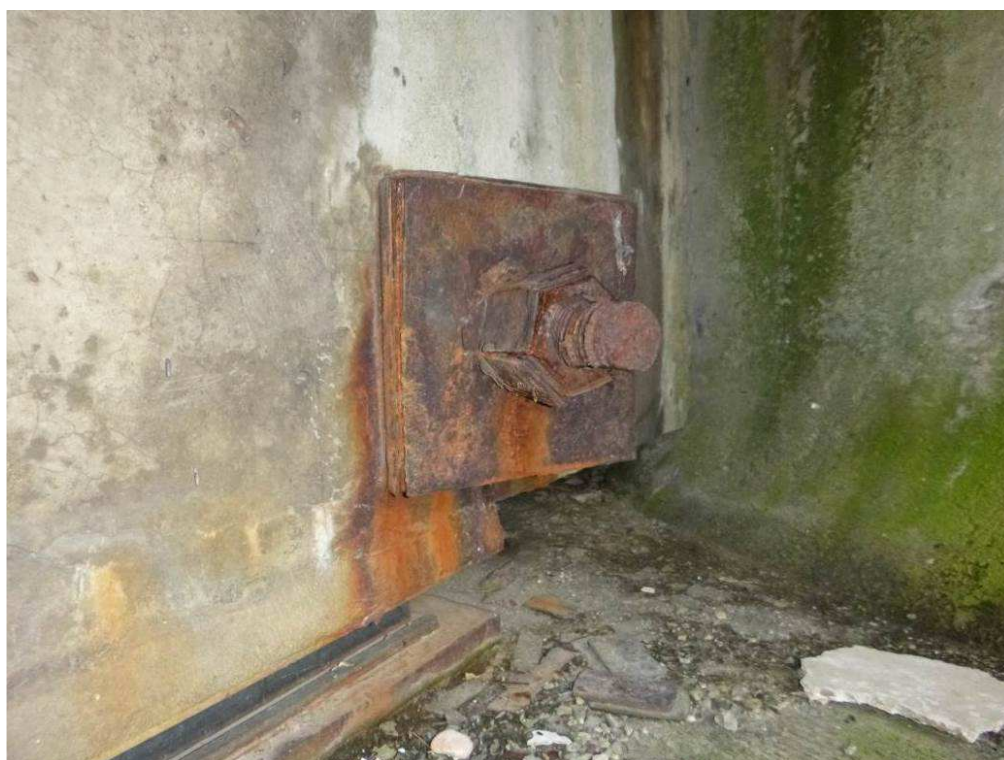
Poutre côté C2, platine et boulon avec une oxydation feuilletante
